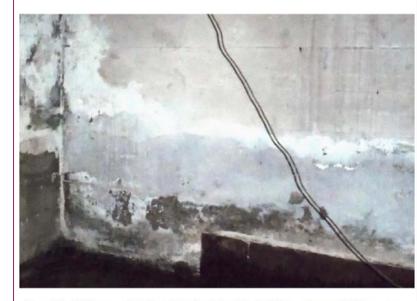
Efflorescences en partie basse du mur de fondation Nord
